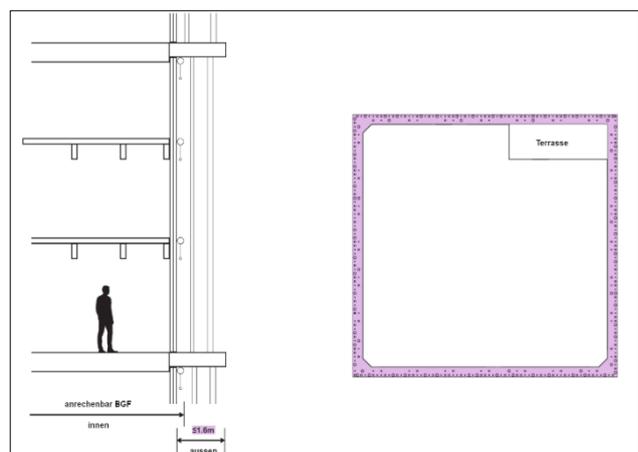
Schemaskizze Fassadenschicht (Fassadenschnitt links, Grundrisschema rechts). Quelle: S&A, 2024
